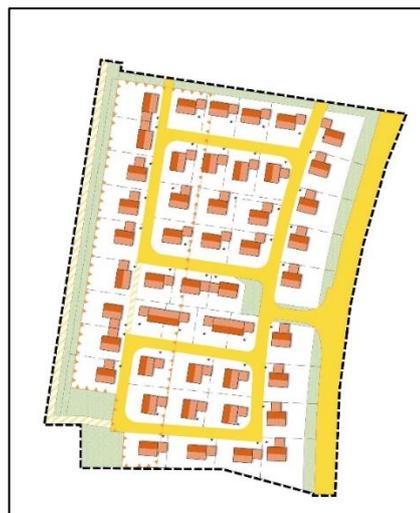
aktuelles städtebauliches Konzept (Grundlage für Bebauungsplan-Entwurf vom 13.12.2021)
